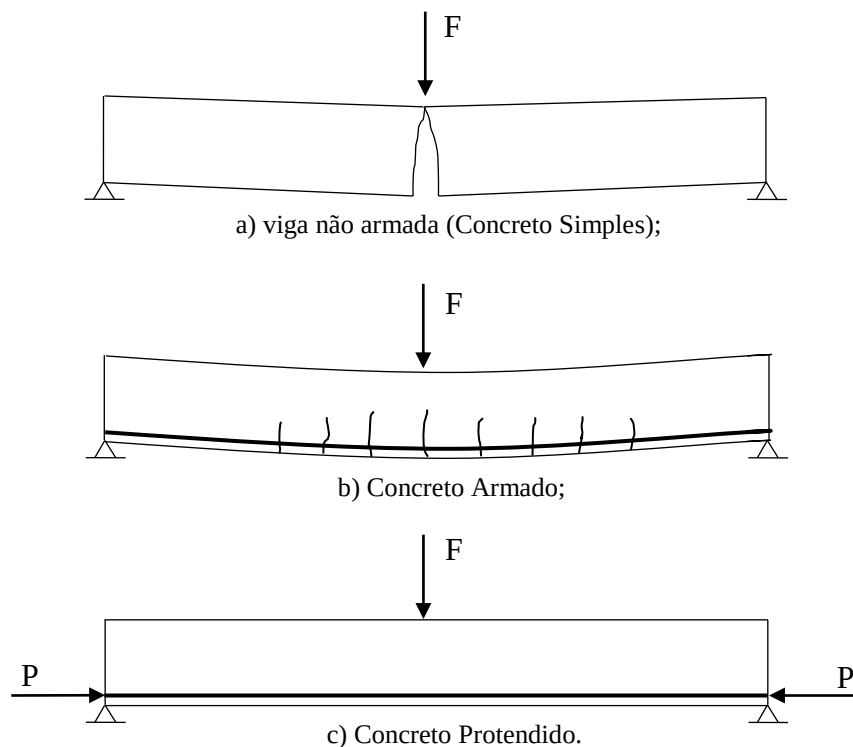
Viga de Concreto Simples, de Concreto Armado e de Concreto Protendido.^[2]
